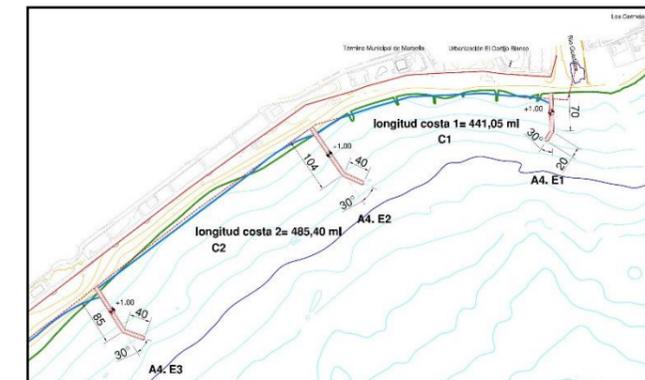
Planta Alternativa 4. C1-C2. Cotas referidas al NMMA.
